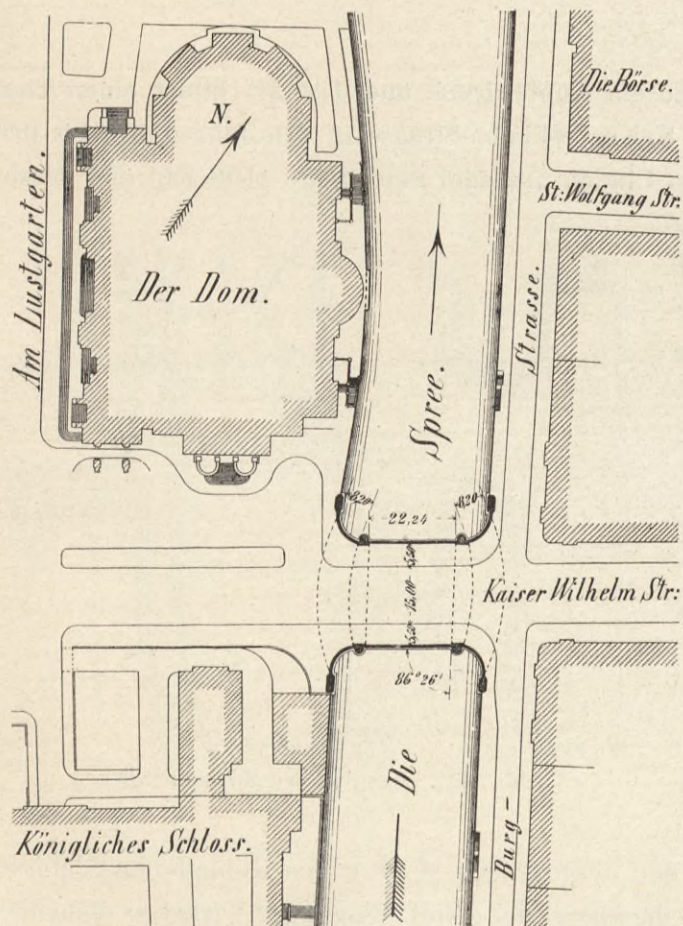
Lageplan der Kaiser Wilhelm-Brücke.
